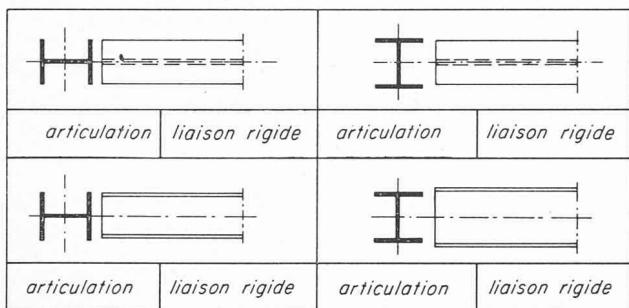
Possibilités d'assemblage de poutrelles dont les axes sont coplanaires.
